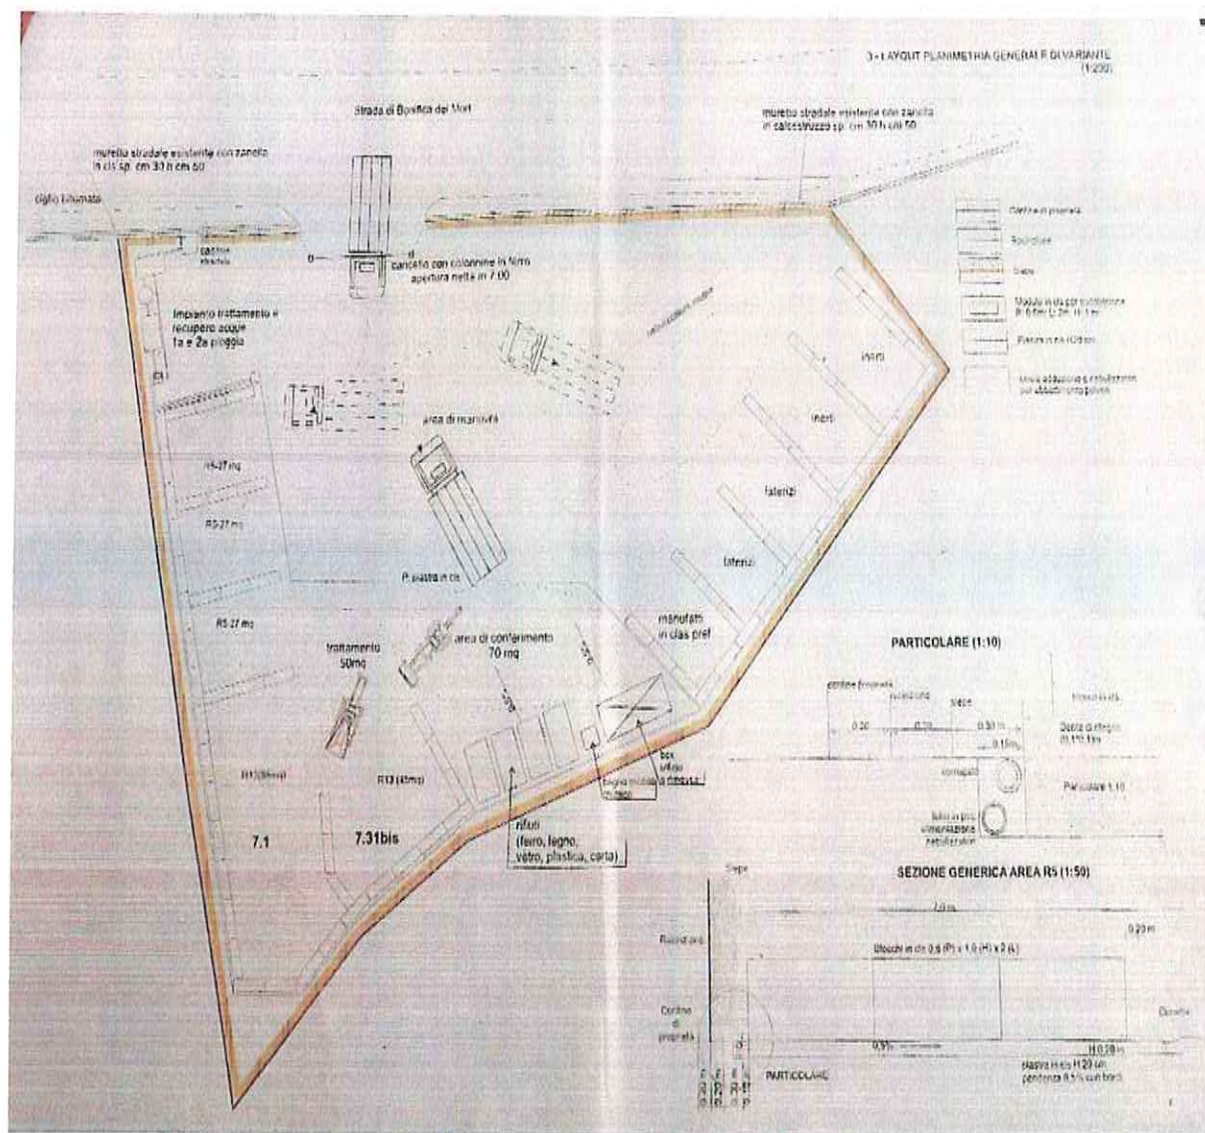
lay-out planimetria generale di variante (scala 1:200).
